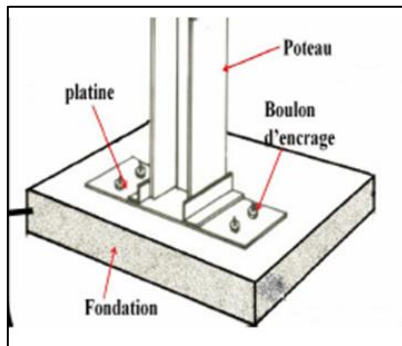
Détail d'encrage du poteau en acier à la fondation.
